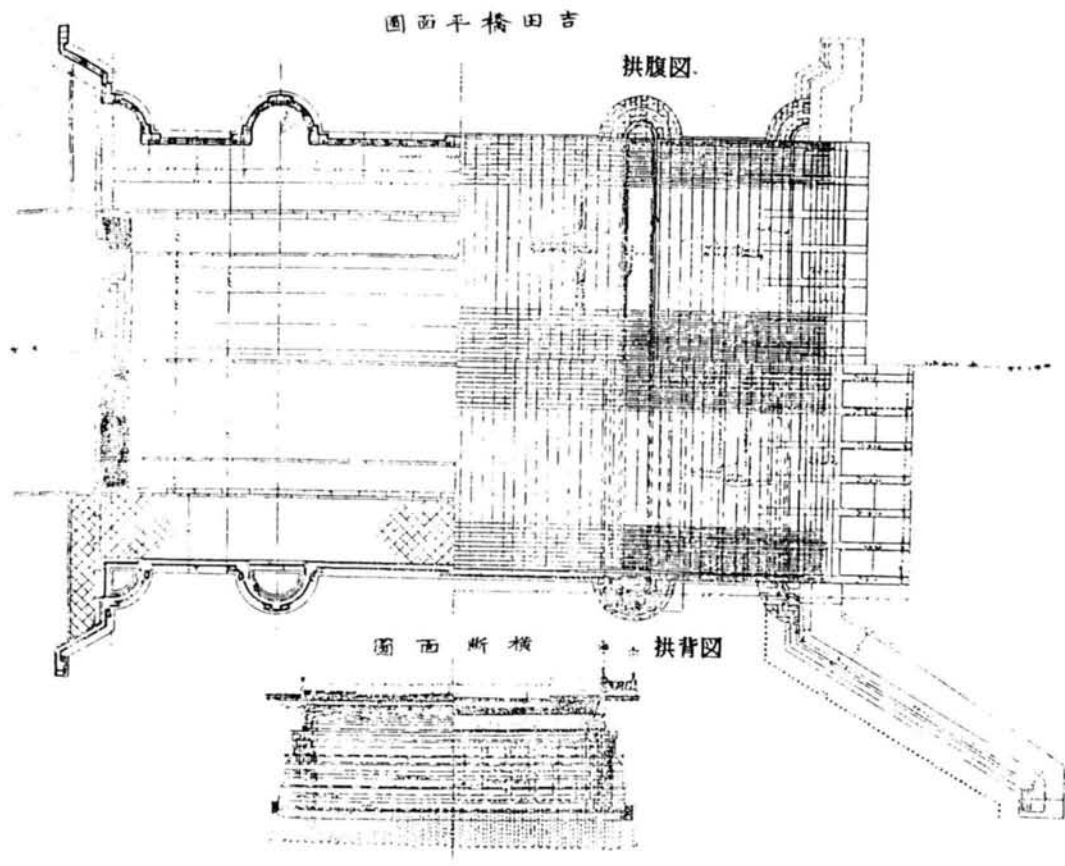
横浜市吉田橋、平面図及び横断面図<sup>61)</sup>
